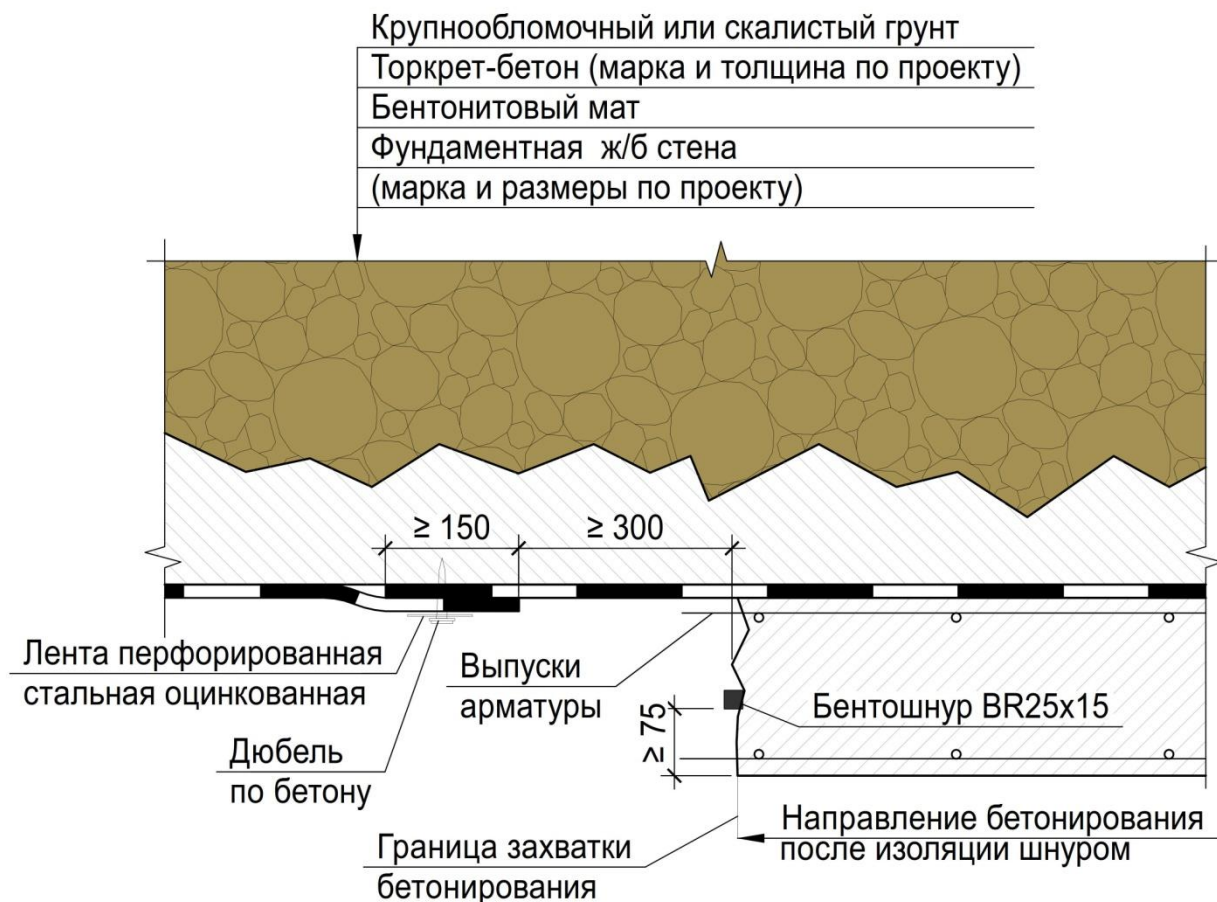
Узел устройства изоляции крепи котлована торкрет – бетоном
